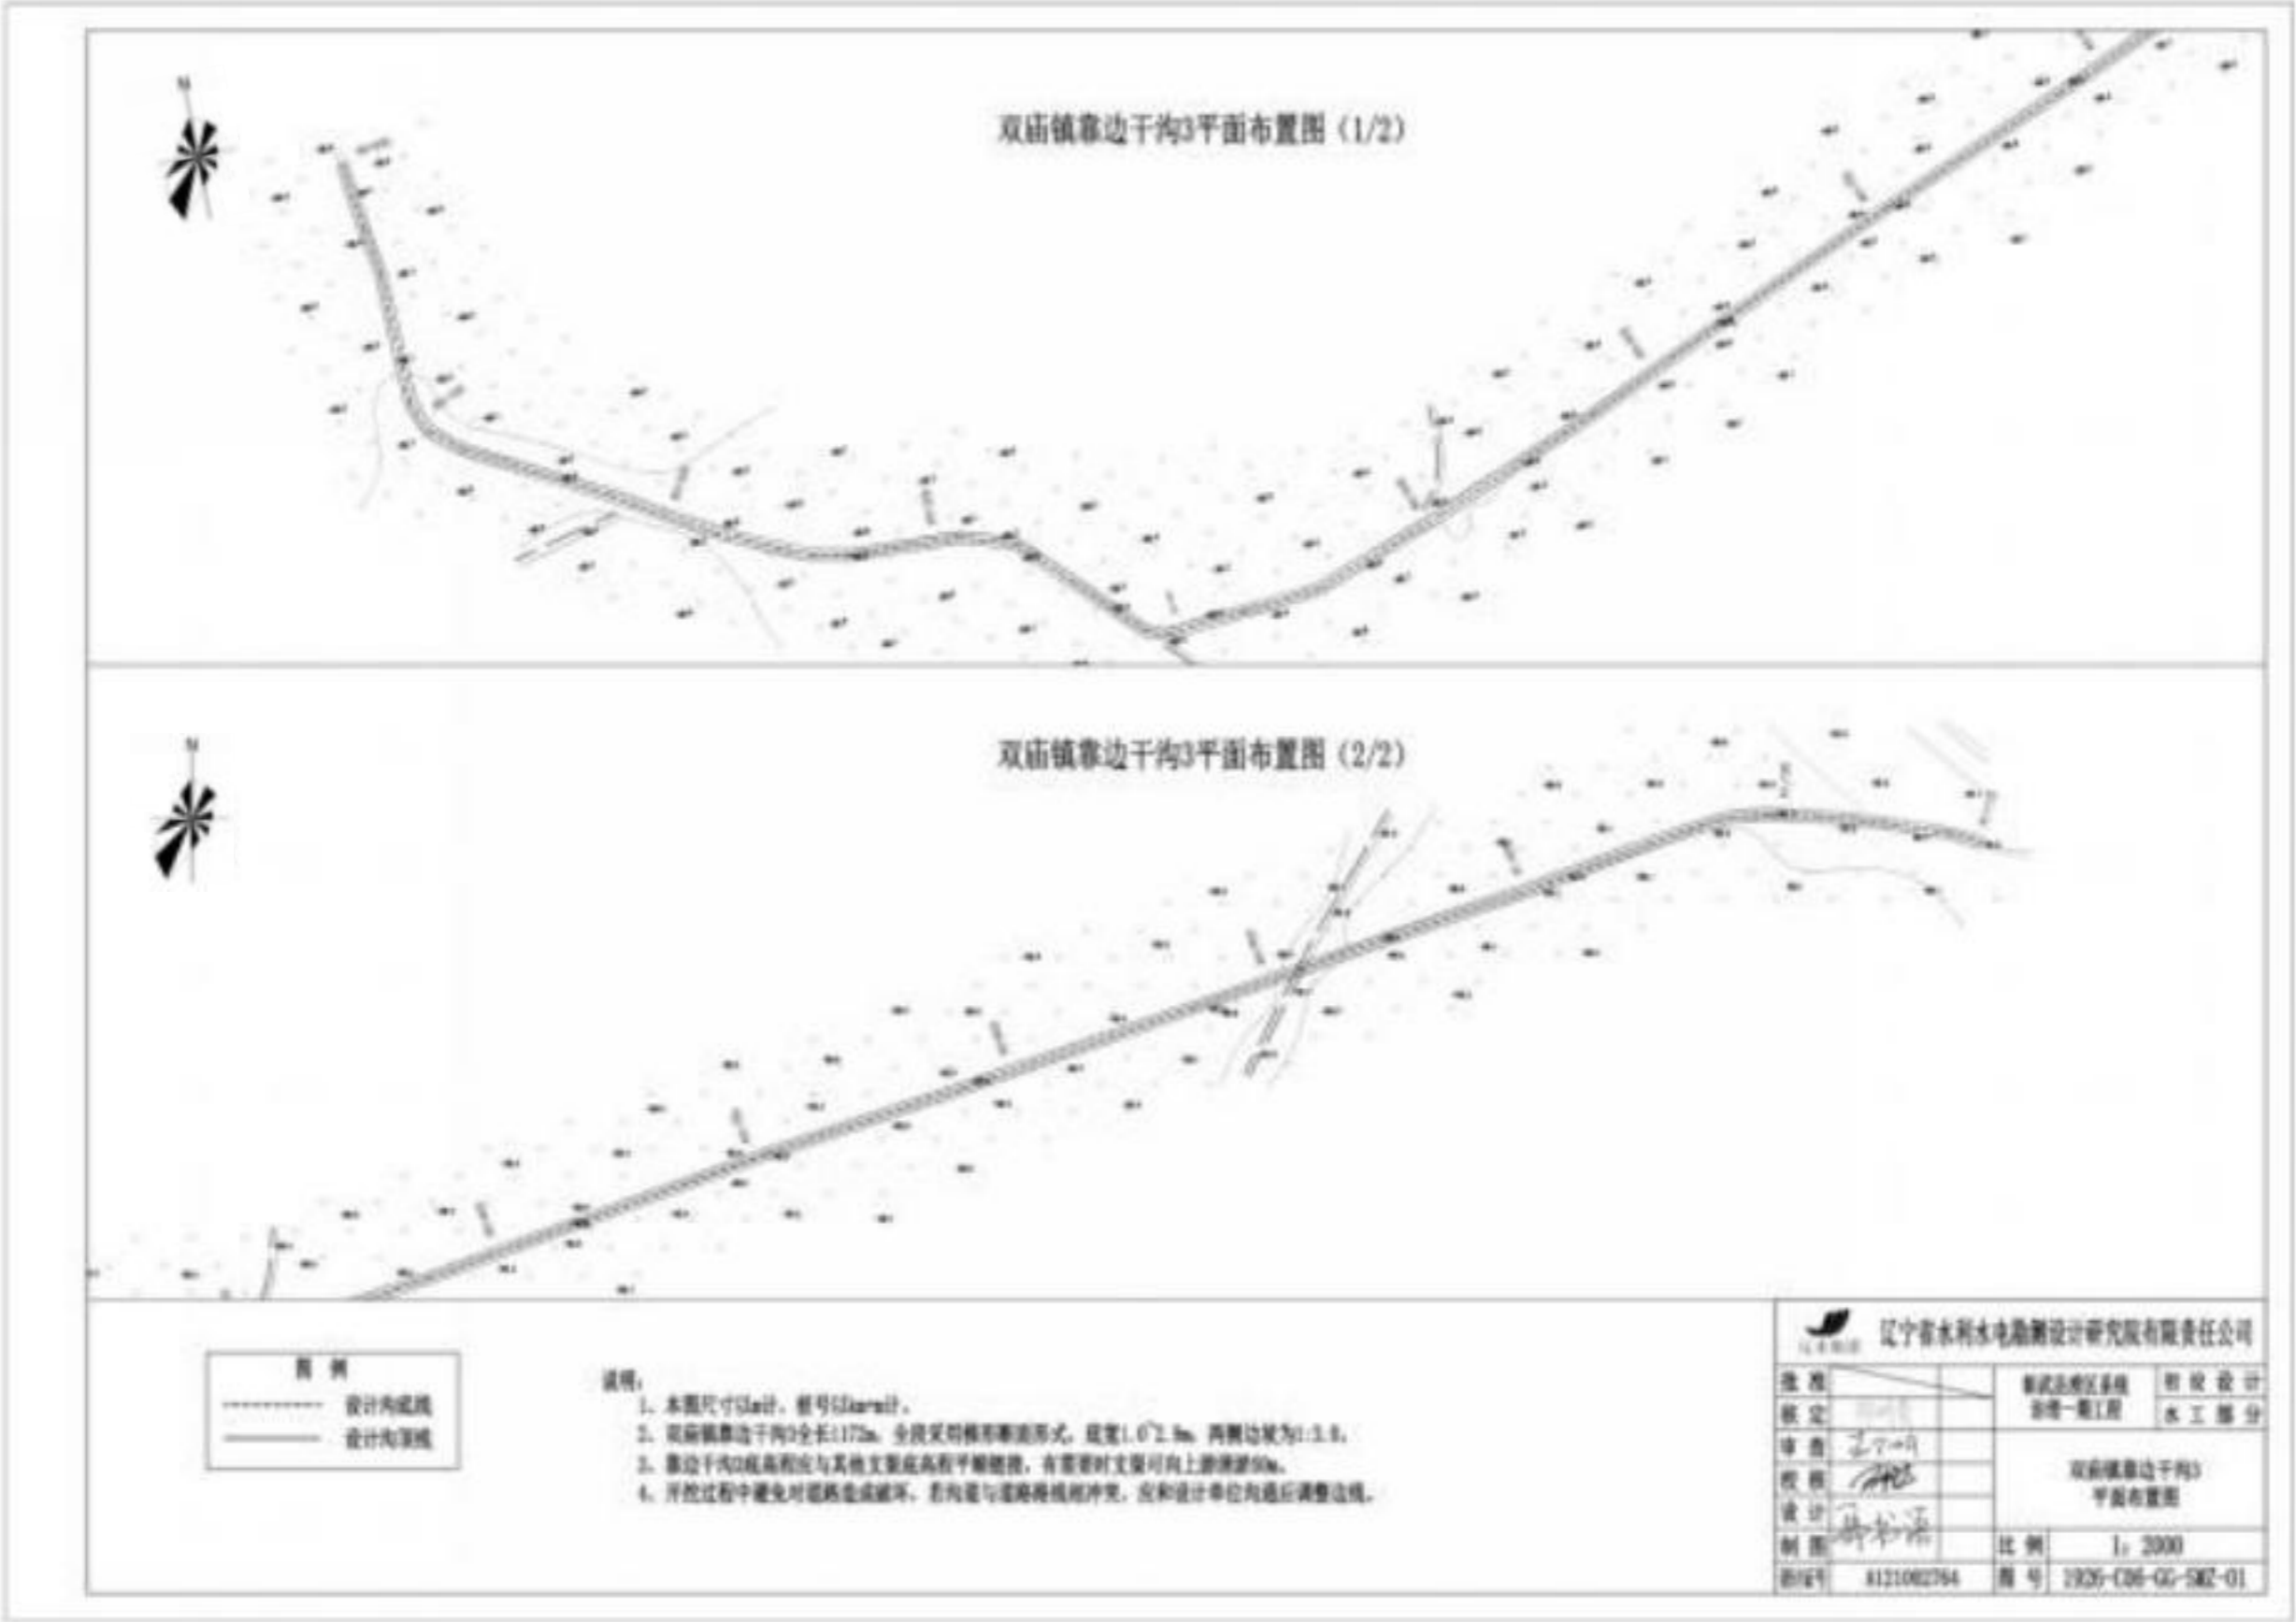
双庙镇靠边干沟 3 平面布置图
